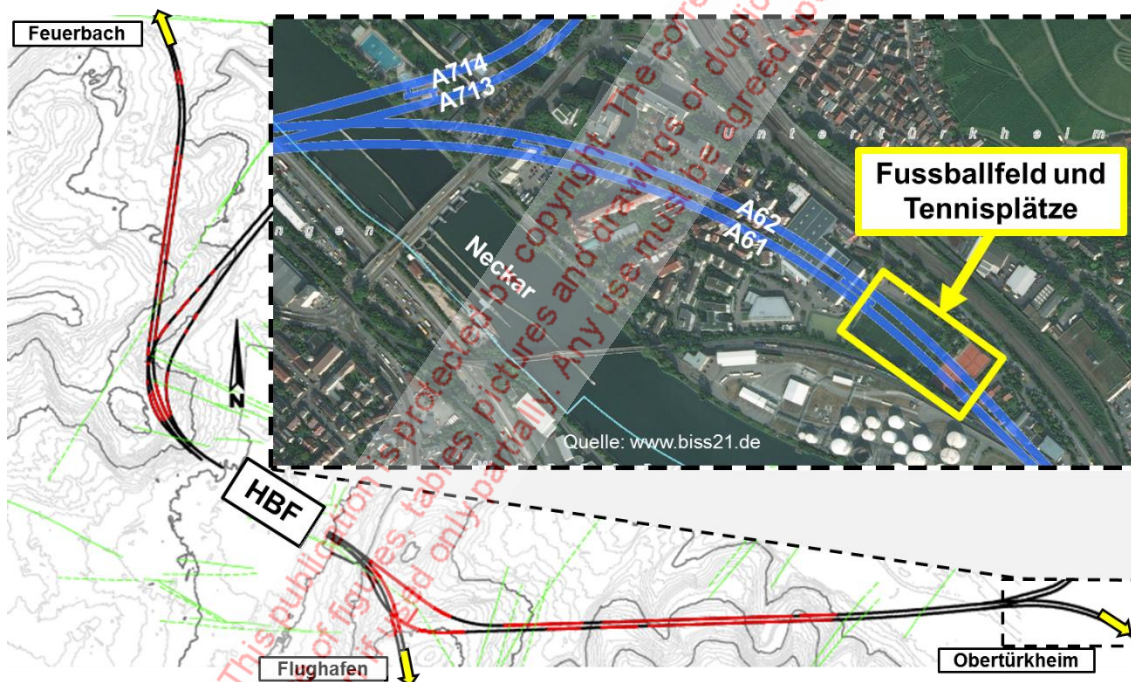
Tunnel nach Ober-/Untertürkheim, Lageplan
